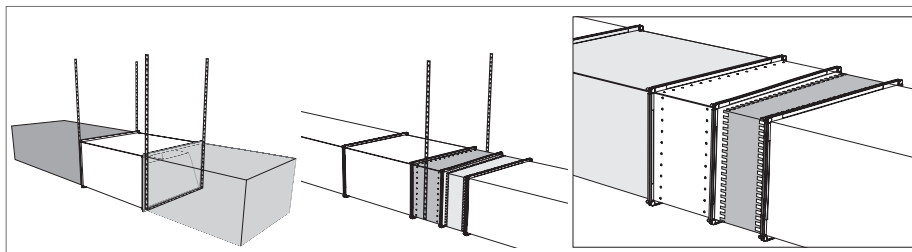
Collegamento del ventilatore al sistema di condotte dell'aria tramite accessori. In caso vengano utilizzati dei collegamenti flessibili, il ventilatore deve essere fissato anche al pavimento, alla parete o al soffitto utilizzando un condotto dell'aria aggiuntivo
